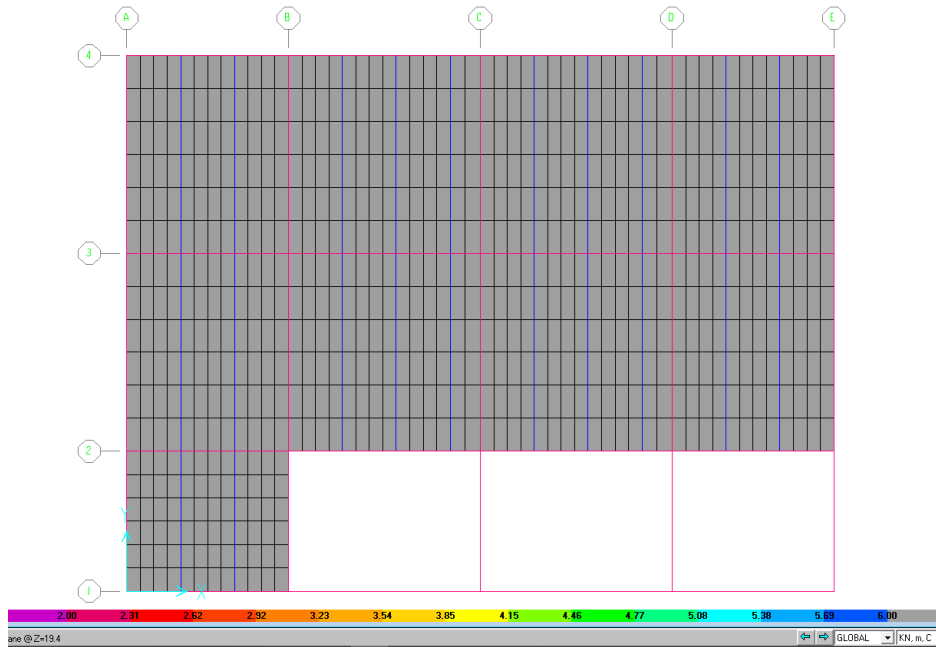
Planta nivel andén módulo de acceso estación 19 costado nor oriental aplicación de la carga viva (6,0 kN/m<sup>2</sup>)
